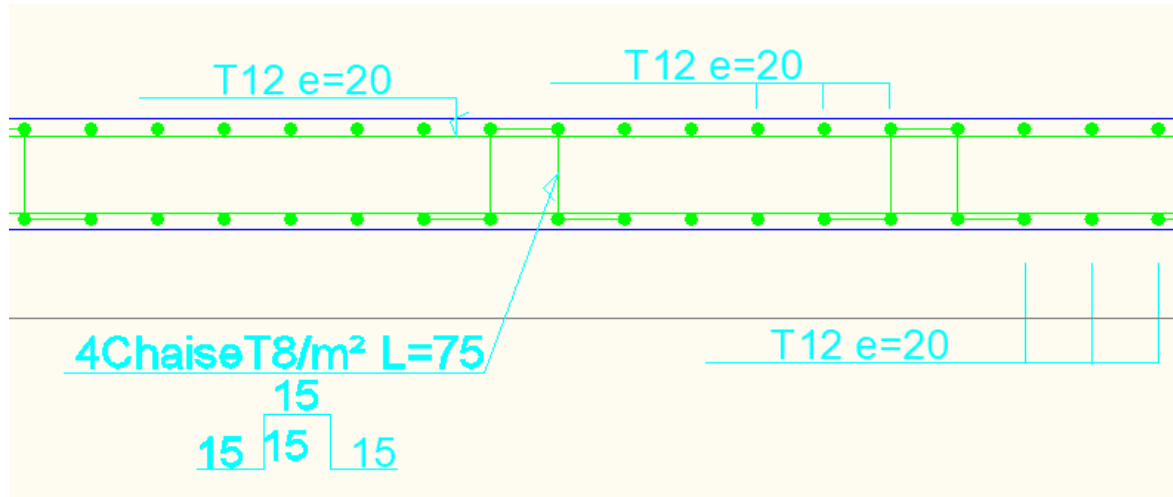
Schéma de ferrailage de la dalle pleine parking.
